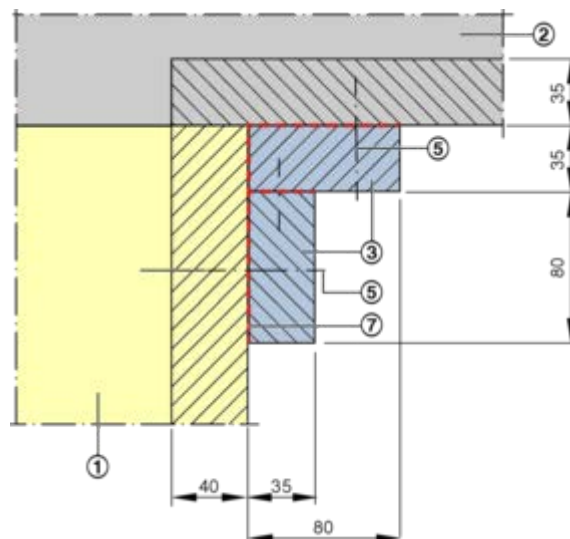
Dettagli di installazione C1: collegamento profilo angolare
